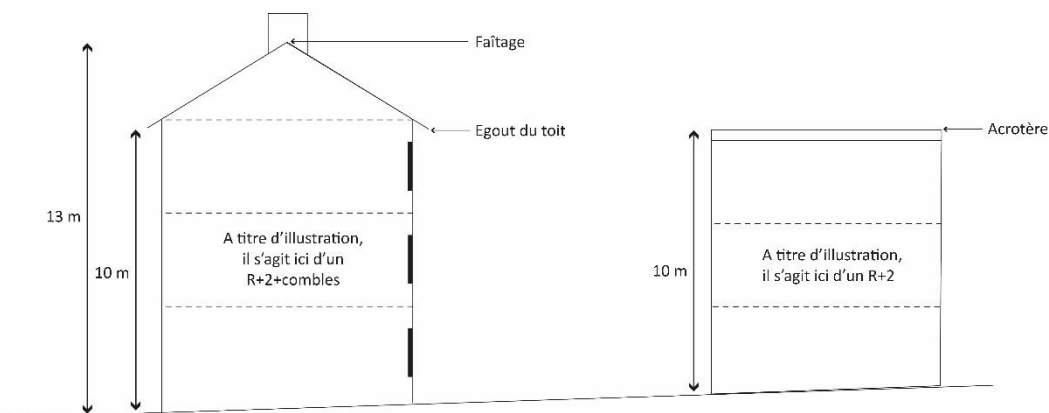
\_Hauteur maximale autorisée en tout point de la construction dans le secteur UB
